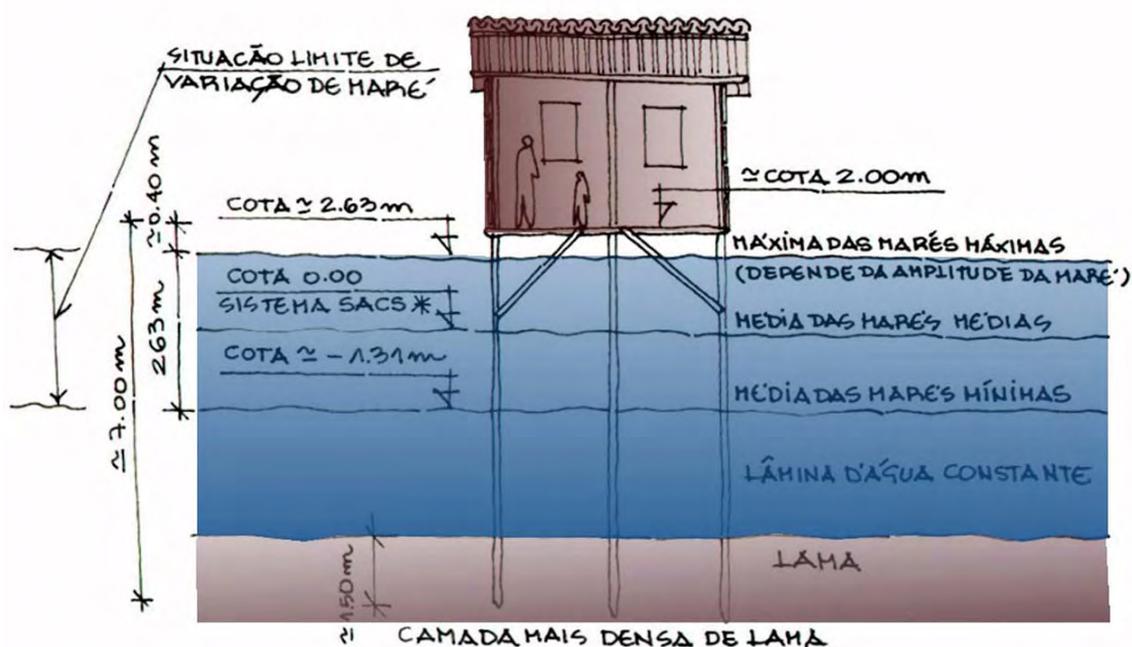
Salvador, Bahia, Alagados - palafitas, esquema construtivo de implantação.
